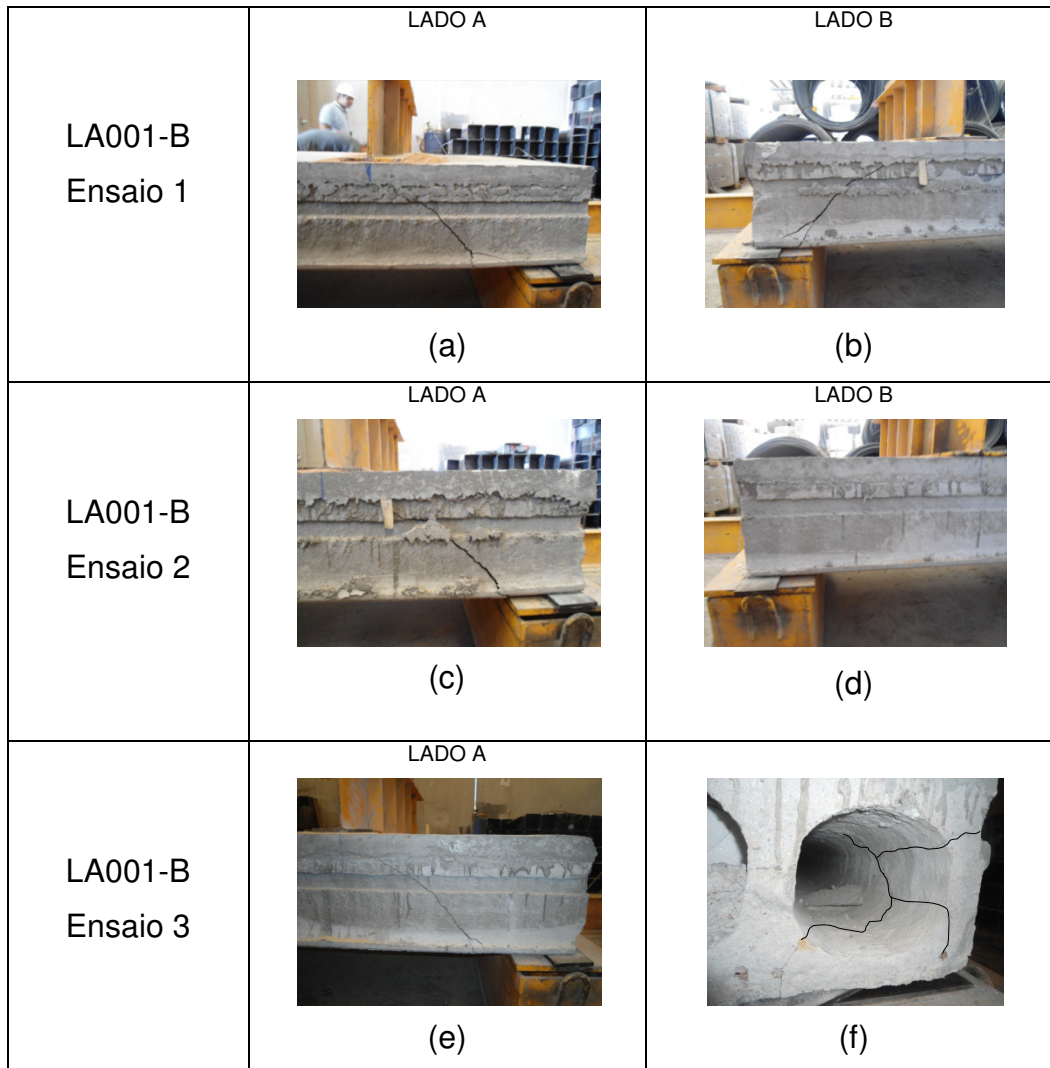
FISSURAS DAS LAJES LA001-B APÓS OS ENSAIOS.
